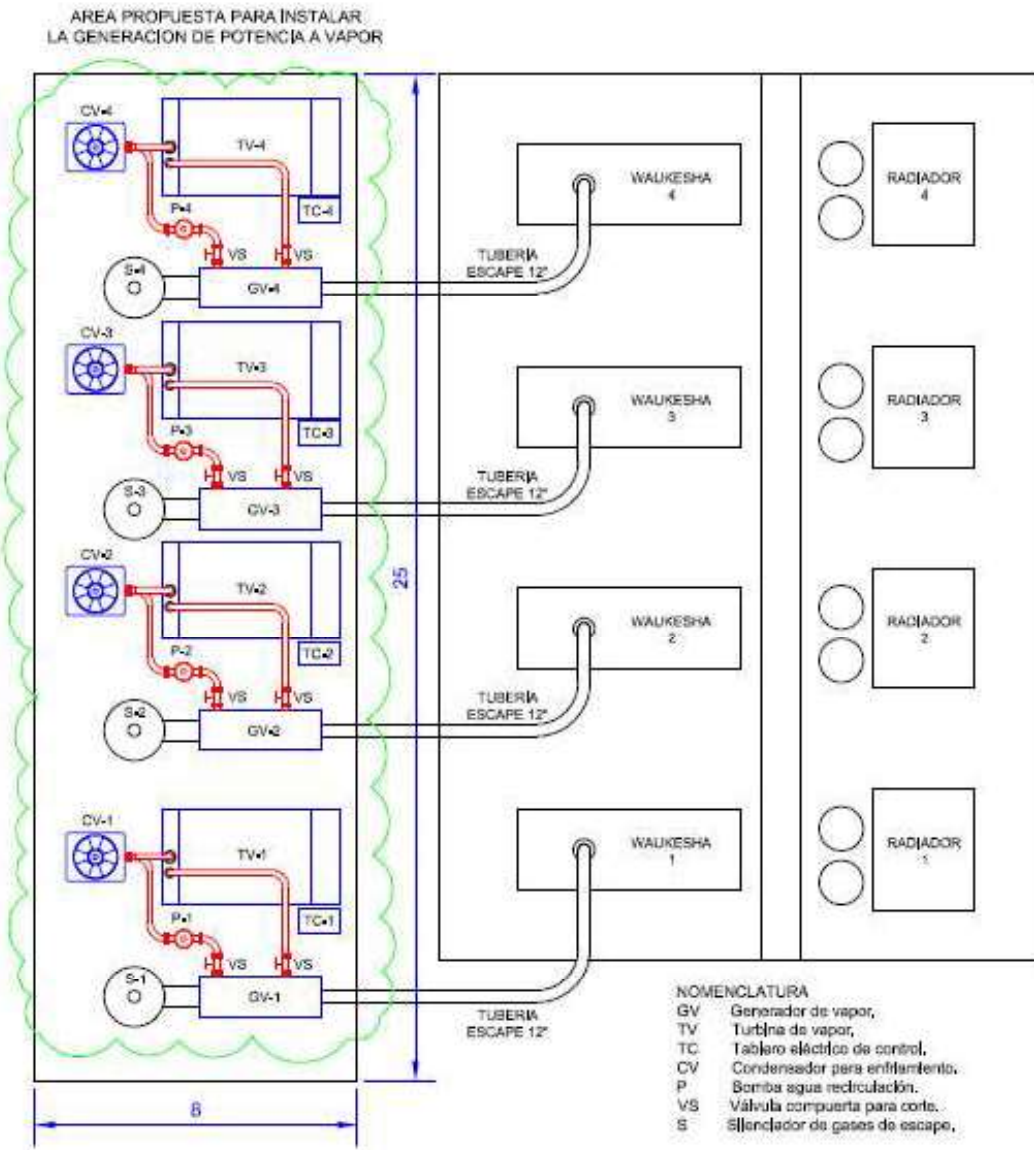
Layout para instalación de propuesta de generación de vapor.
